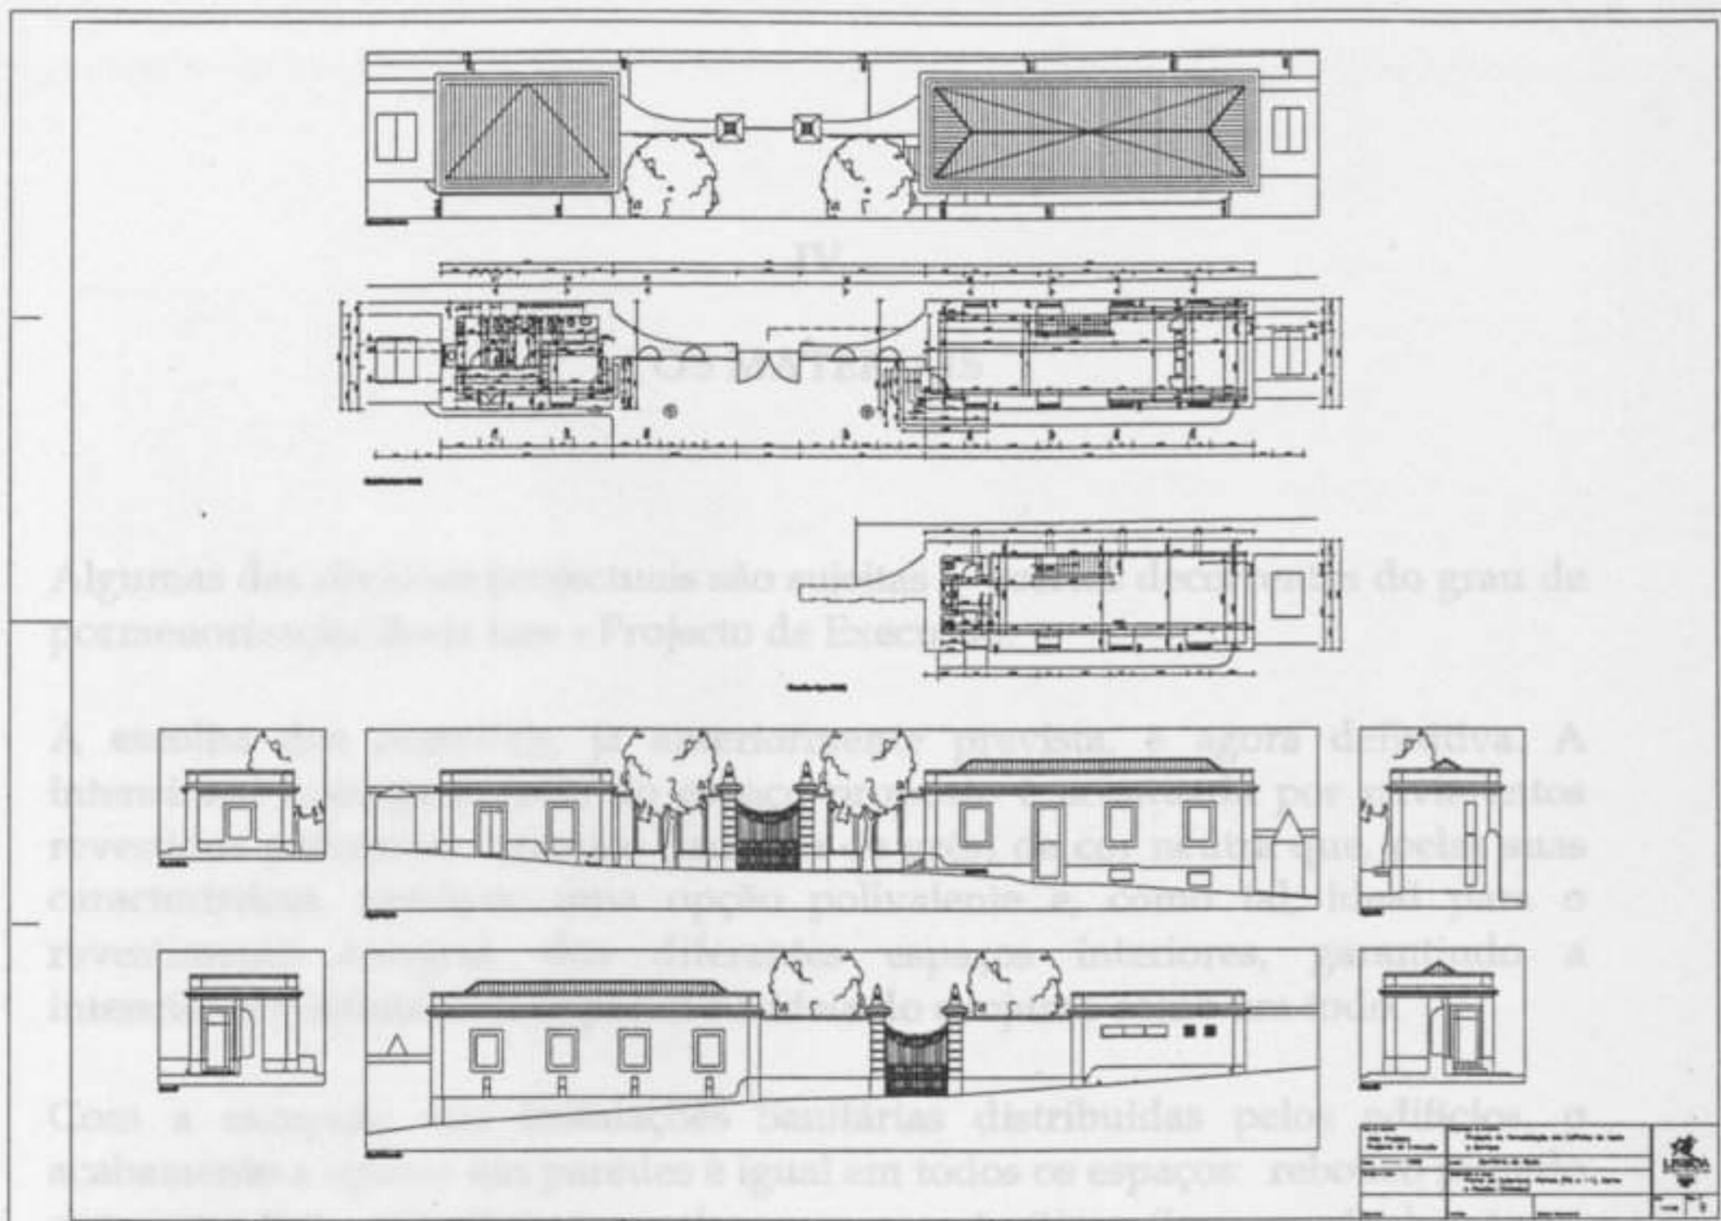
Ante-Projecto - Planta de Cobertura, Plantas e Alçados Cotados - Esc. 1/100 - Des. n° 9.
